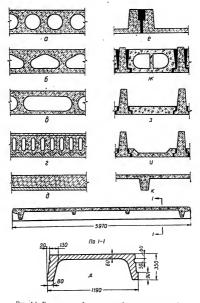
Конструкции сборных железобетонных перекрытий:
